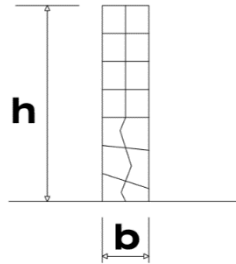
Instabilidade local dos pilares centrais inferiores
